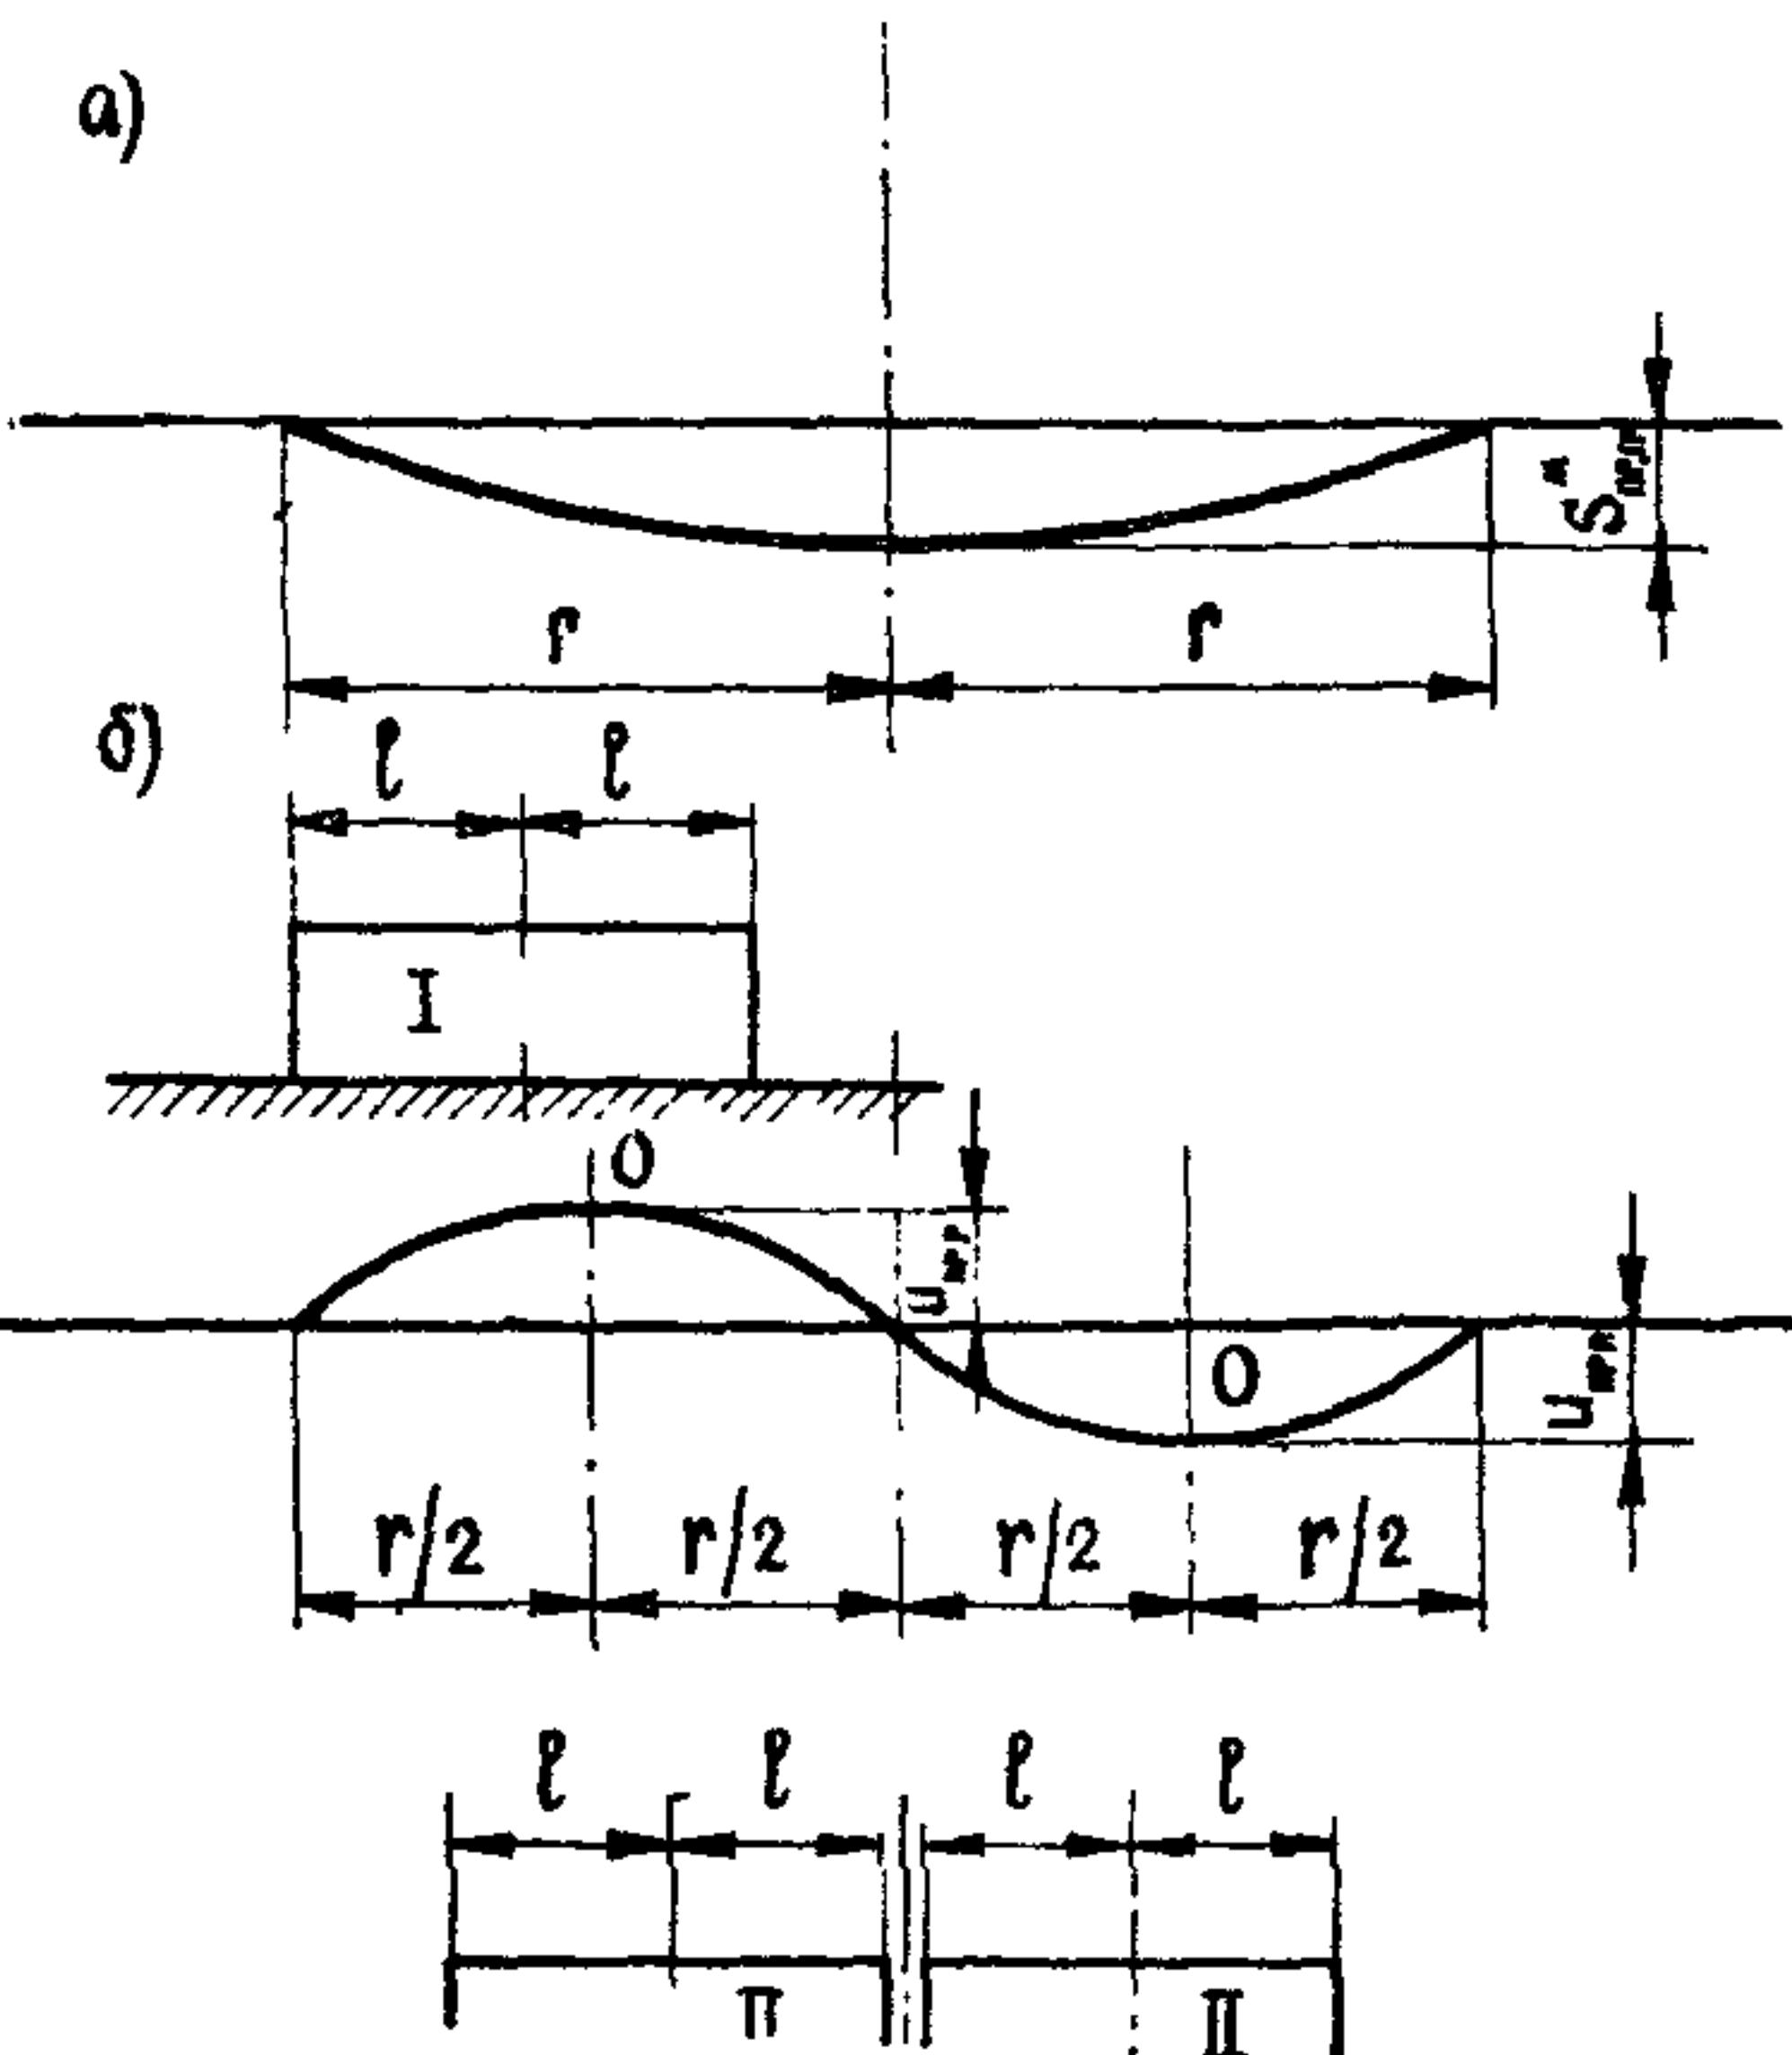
Основные расчетные варианты расположения зданий или их отсеков на кривой просадки поверхности грунта от собственной массы:
